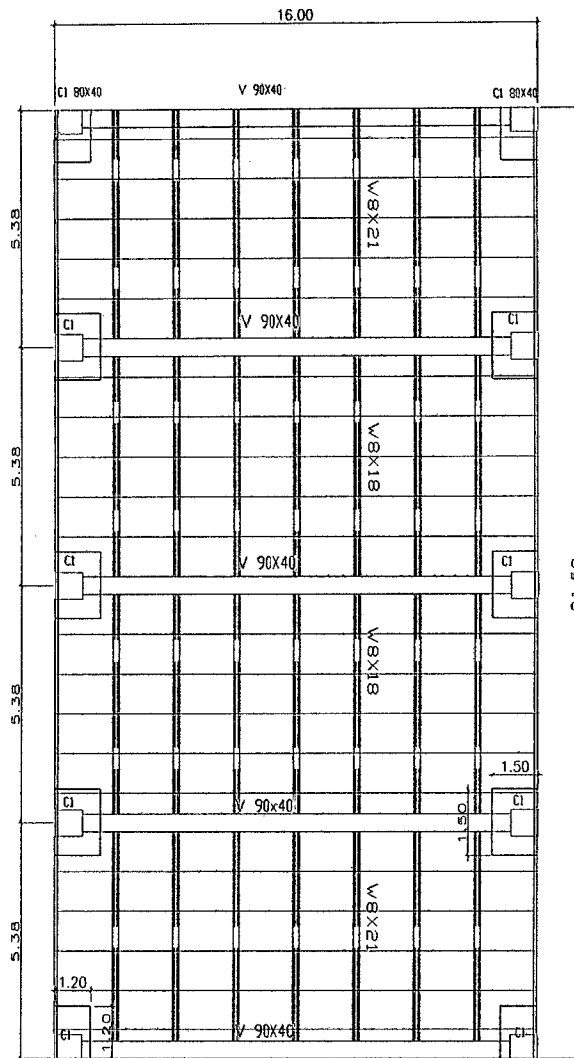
Pórtico estructurado para Losa Colaborante.
